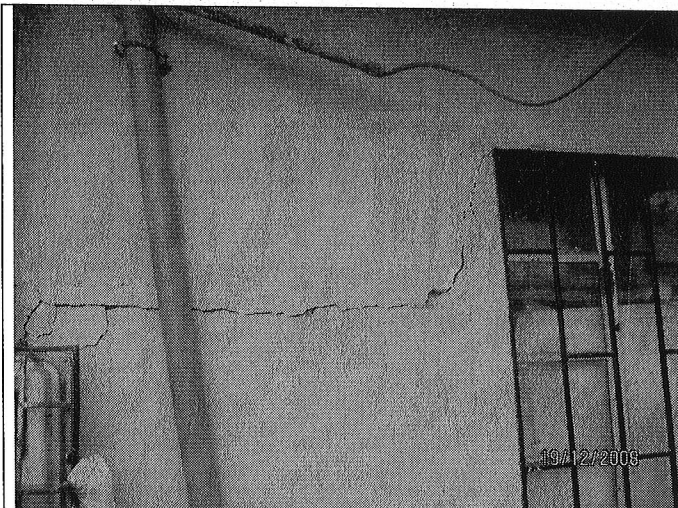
Fisura en muro, presentada en el costado sur, del lote 13 de la manzana 5, con un ancho de 2mm aproximadamente (De acuerdo a la Figura 1)
